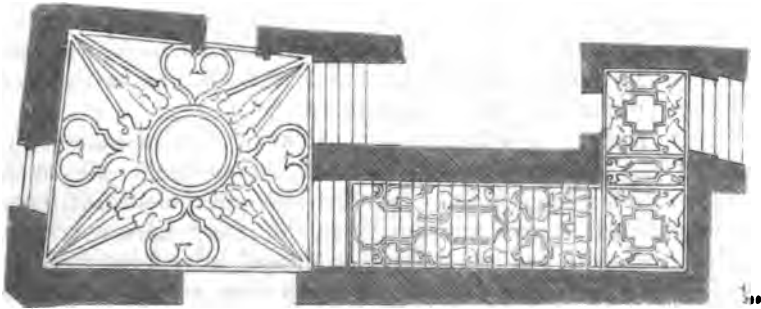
München. Residenz. Grundriss einer Treppe.
